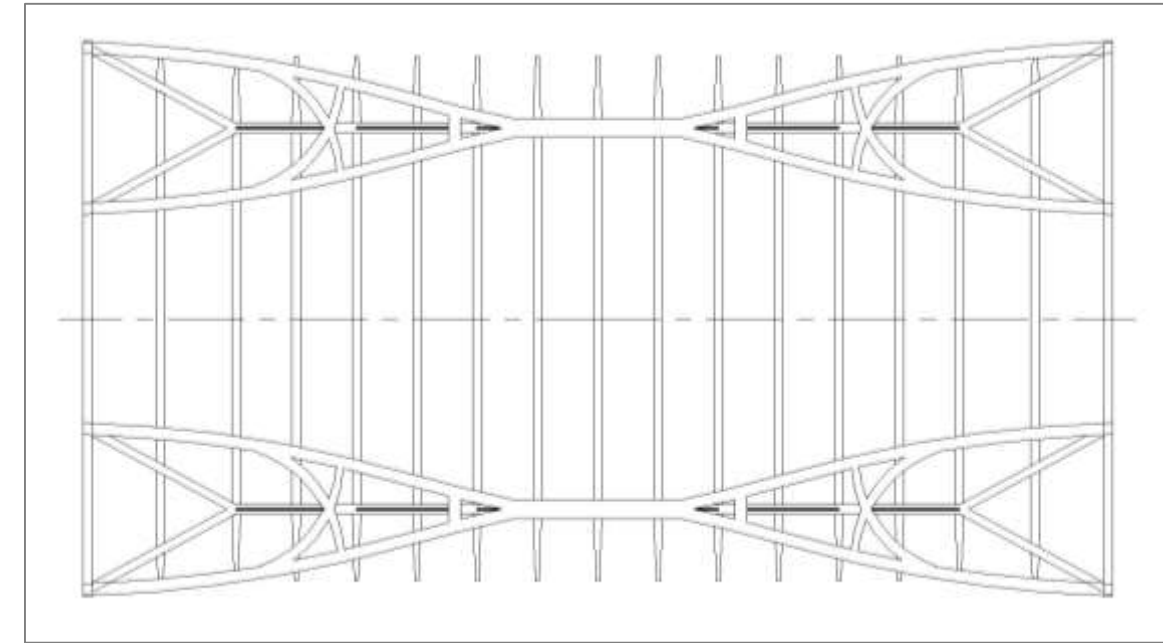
Planta de la estructura metálica. Fuente: Elaboración propia.
